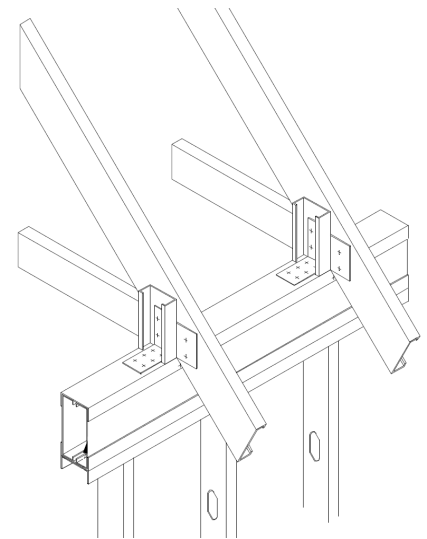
Viga tubo para repartir las cargas en cubierta.
